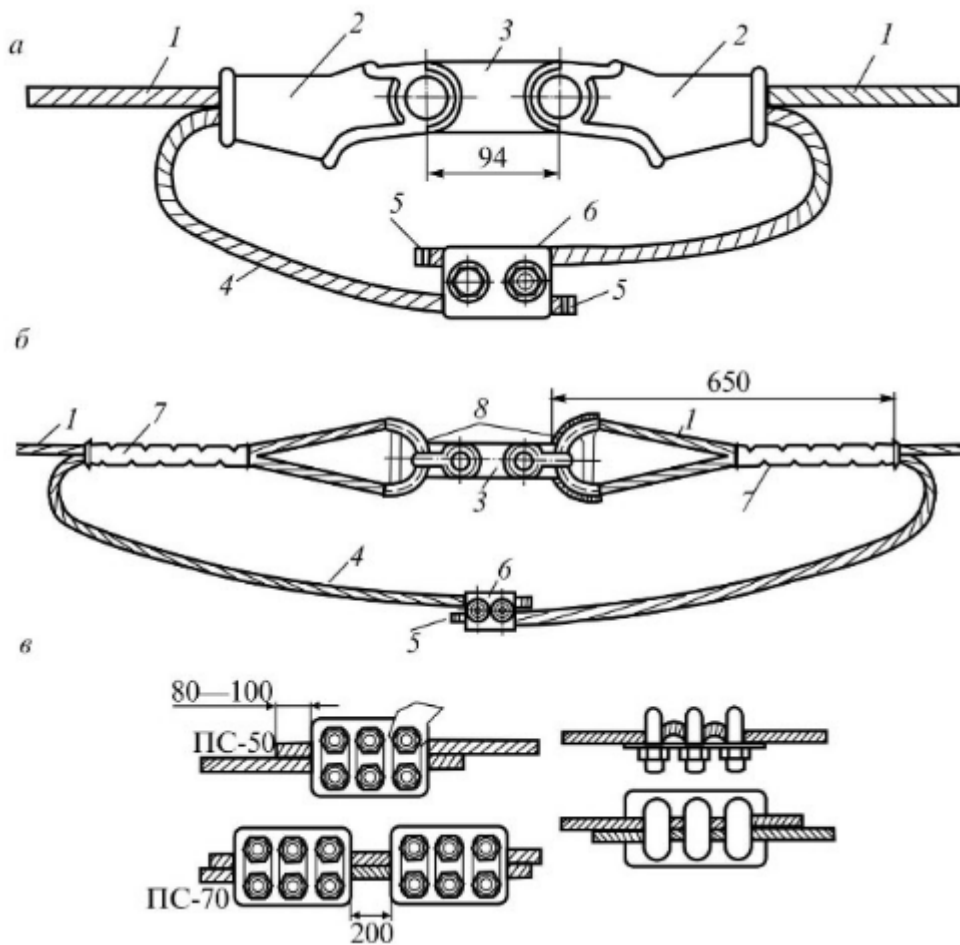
З'єднання проводів: а - контактних, сталемедний з натягом менше 15 кН; б - із міді в - сталевих; 1 - трос (контактний провід); 2 - клиновий затискач; 3 - сполучна планка; 4 - шунт; 5 - бандаж; б - з'єднувальний затискач; 7 - овальний з'єднувач; 8 - навантажувач коуш
